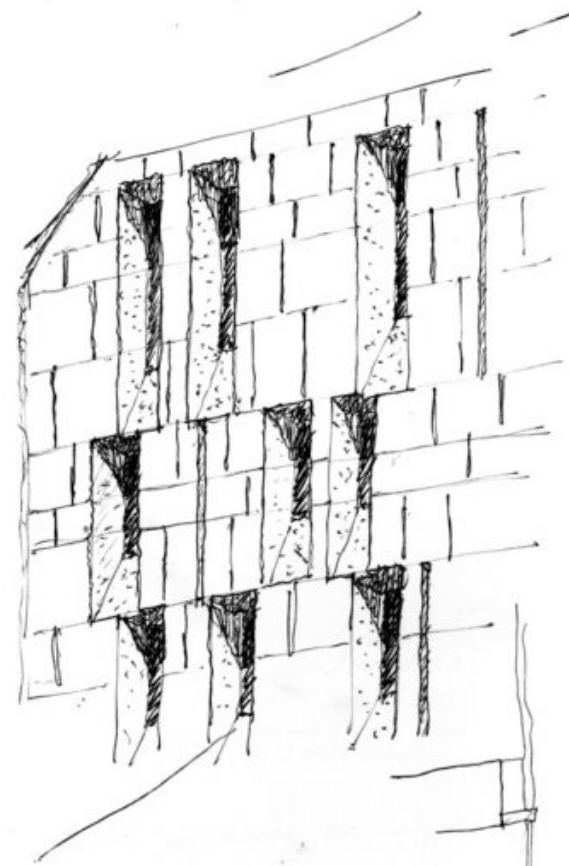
Croqui das Janelas das Fachadas Exteriores.
